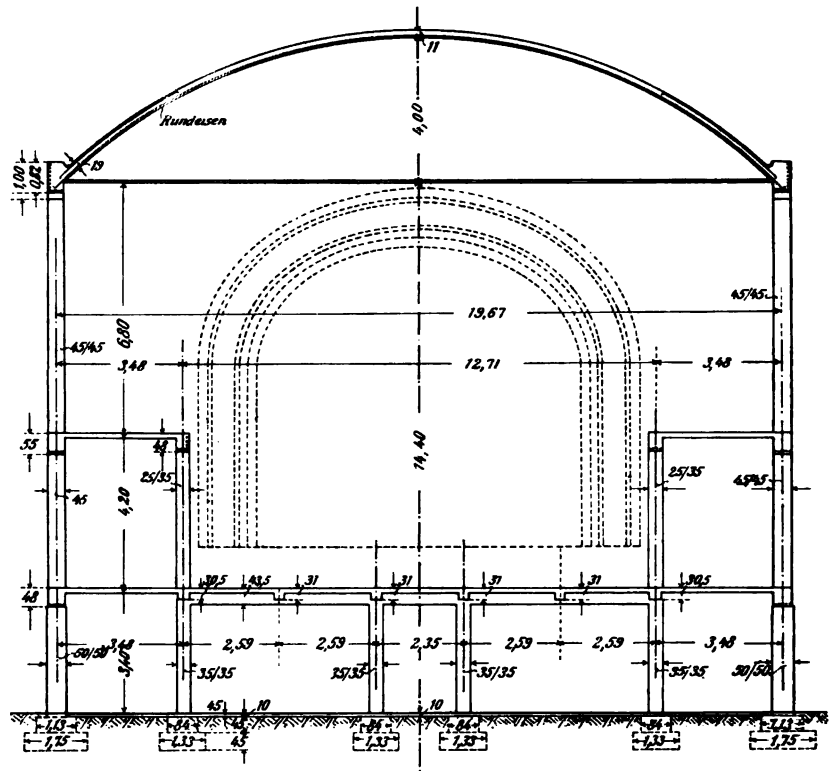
Saalbau in Frankfurt a. d. Oder.
